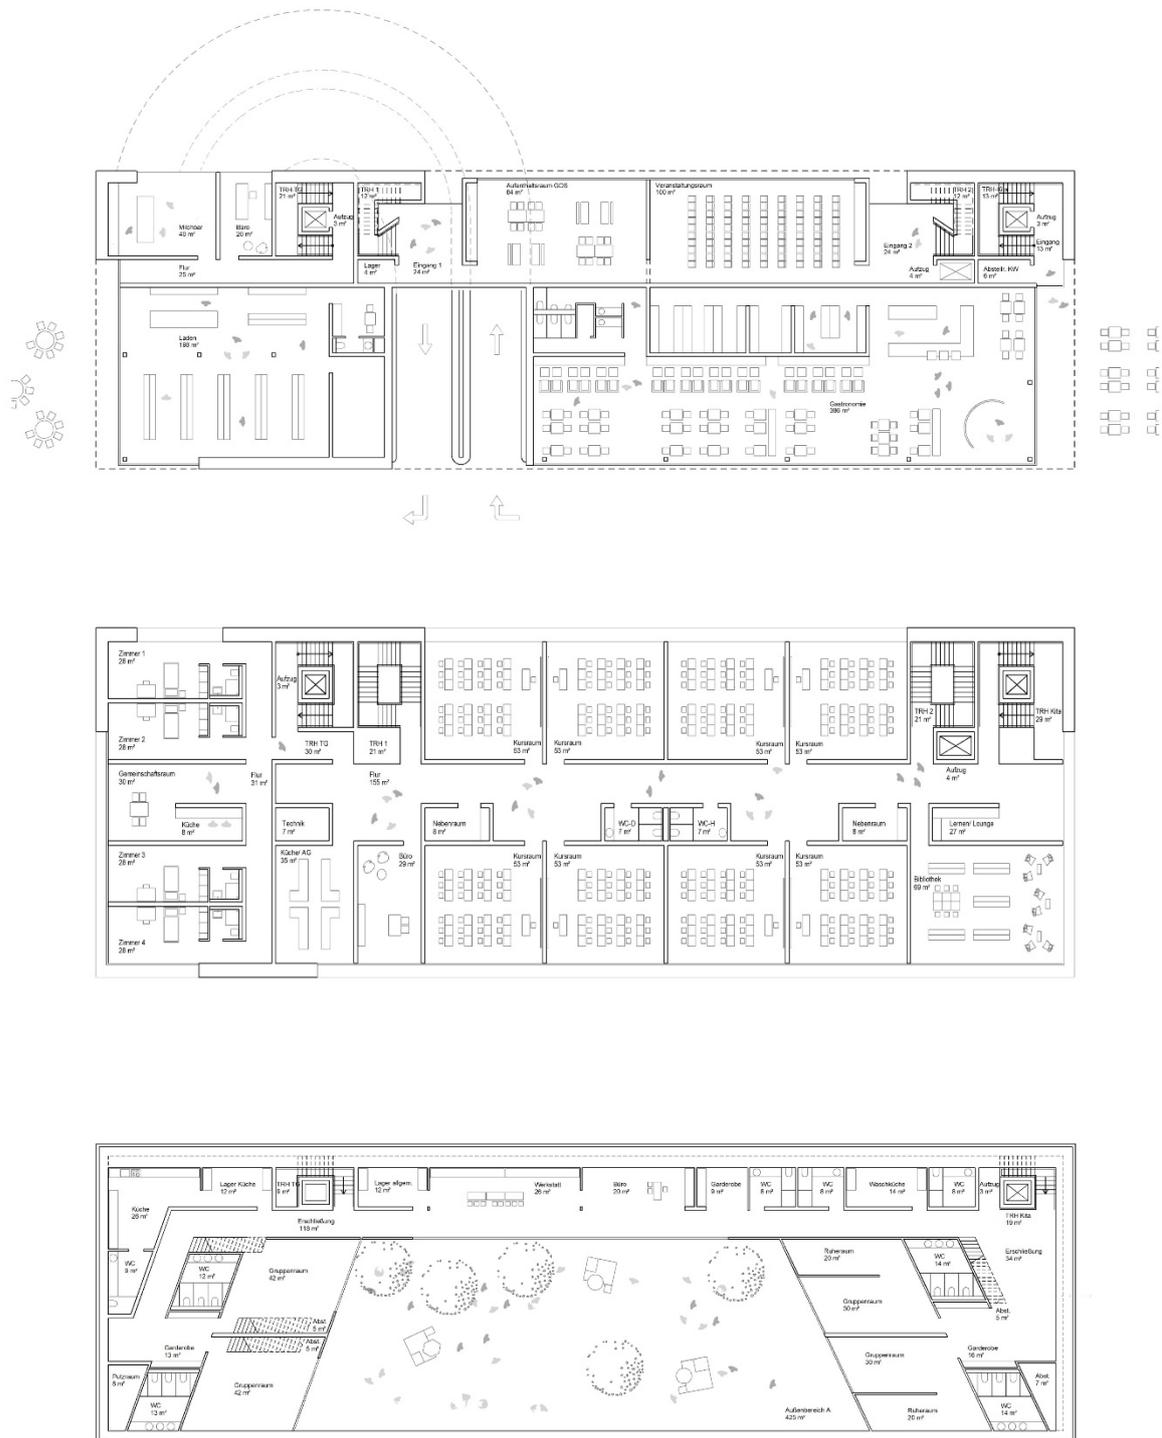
Grundrisse EG, 1.OG, DG Wettbewerbsentwurf Zaeske und Partner
